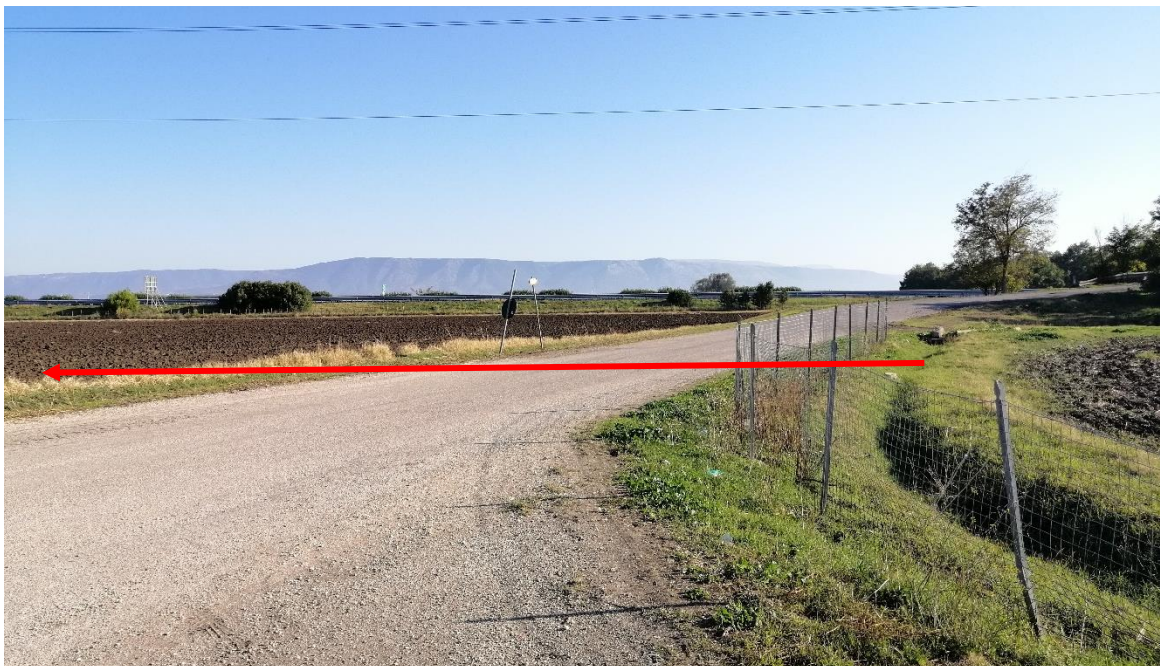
Attraversamento strada comunale Ponte Amendola
